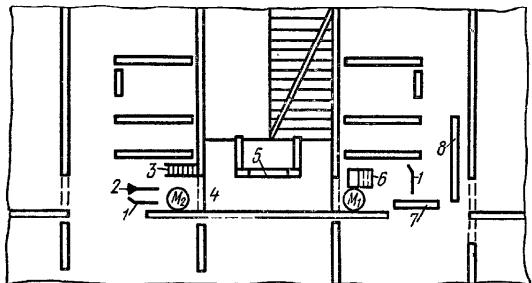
Организация рабочего места при монтаже лестничной площадки:
